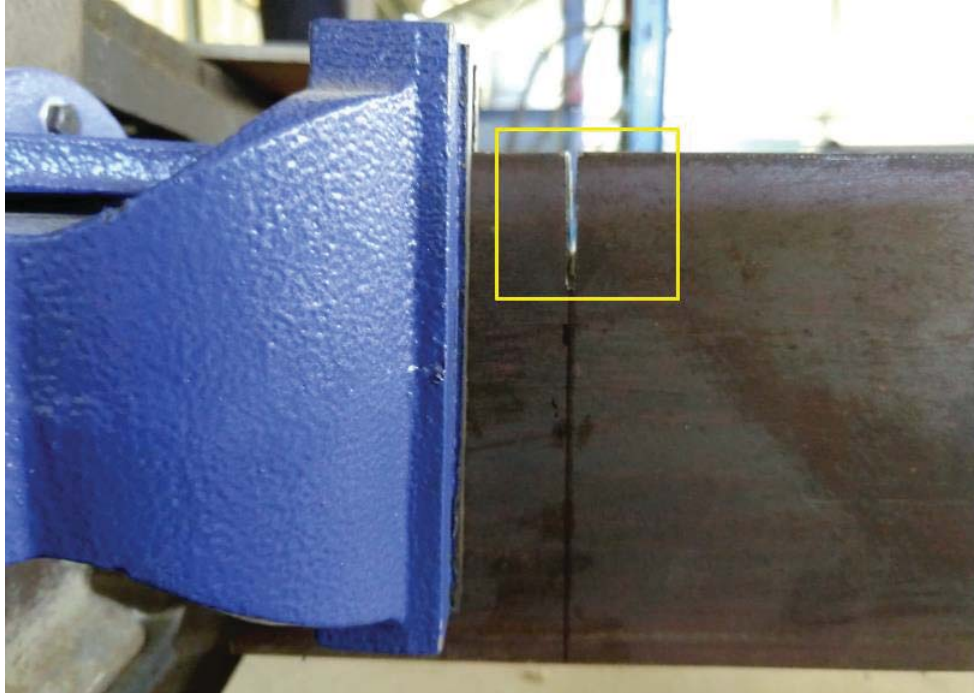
Viga con grieta avanzada, 17 [mm] de profundidad.
